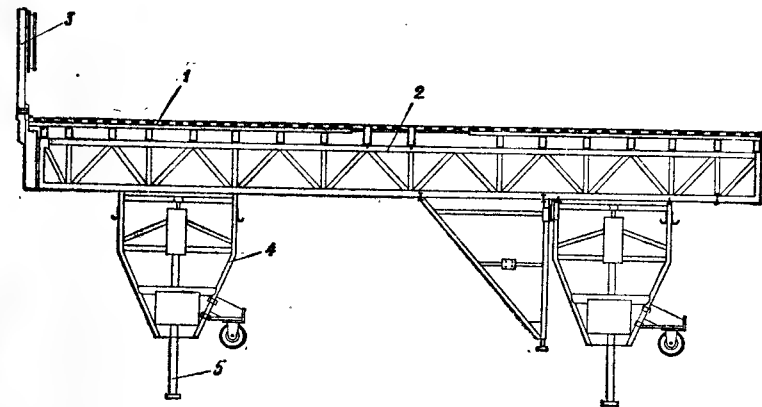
«Столовая» опалубка, подготовленная для установки на перекрытие этажа
